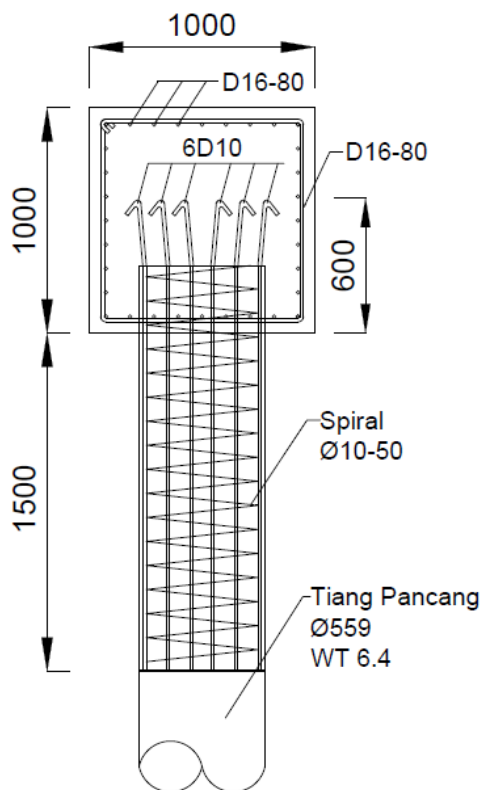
Gambar Potongan Balok Memanjang Trestle
